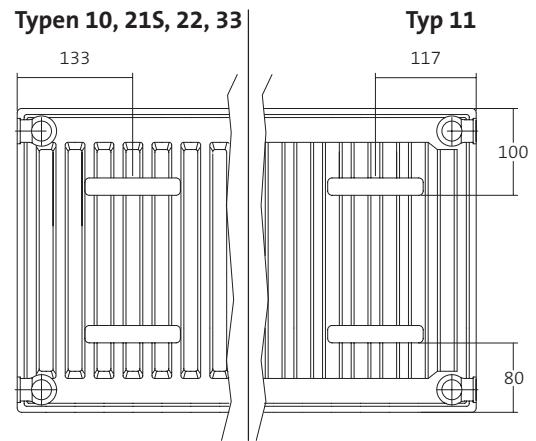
Laschenmaße für Ramo Compact mit Befestigungslaschen (Rückansichten)
